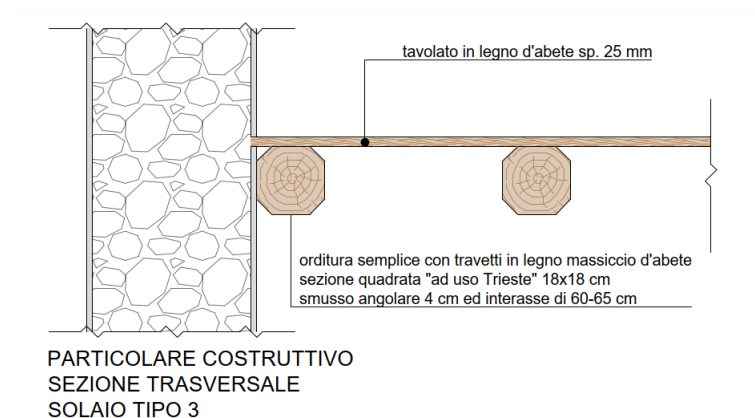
Particolare costruttivo Solaio tipologia 3 - Sezione trasversale
